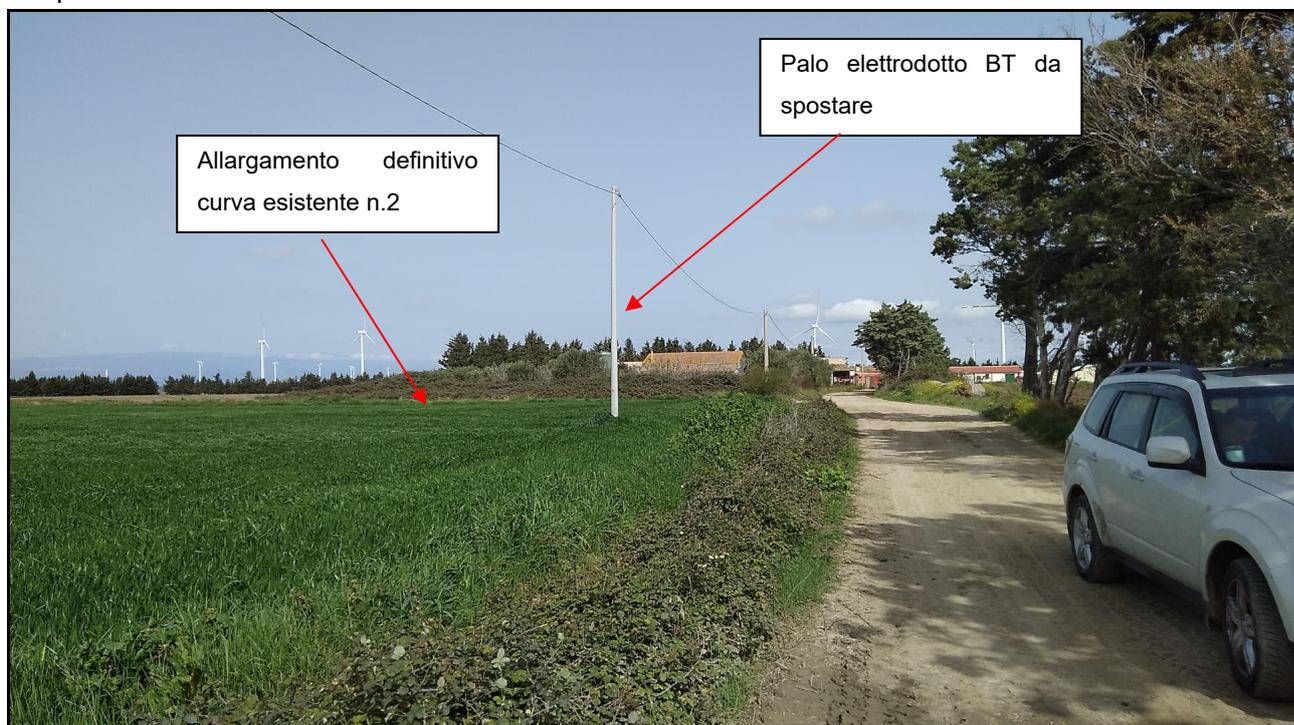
Foto n.3 di figura n.41 Area di allargamento definitivo della strada esistente
